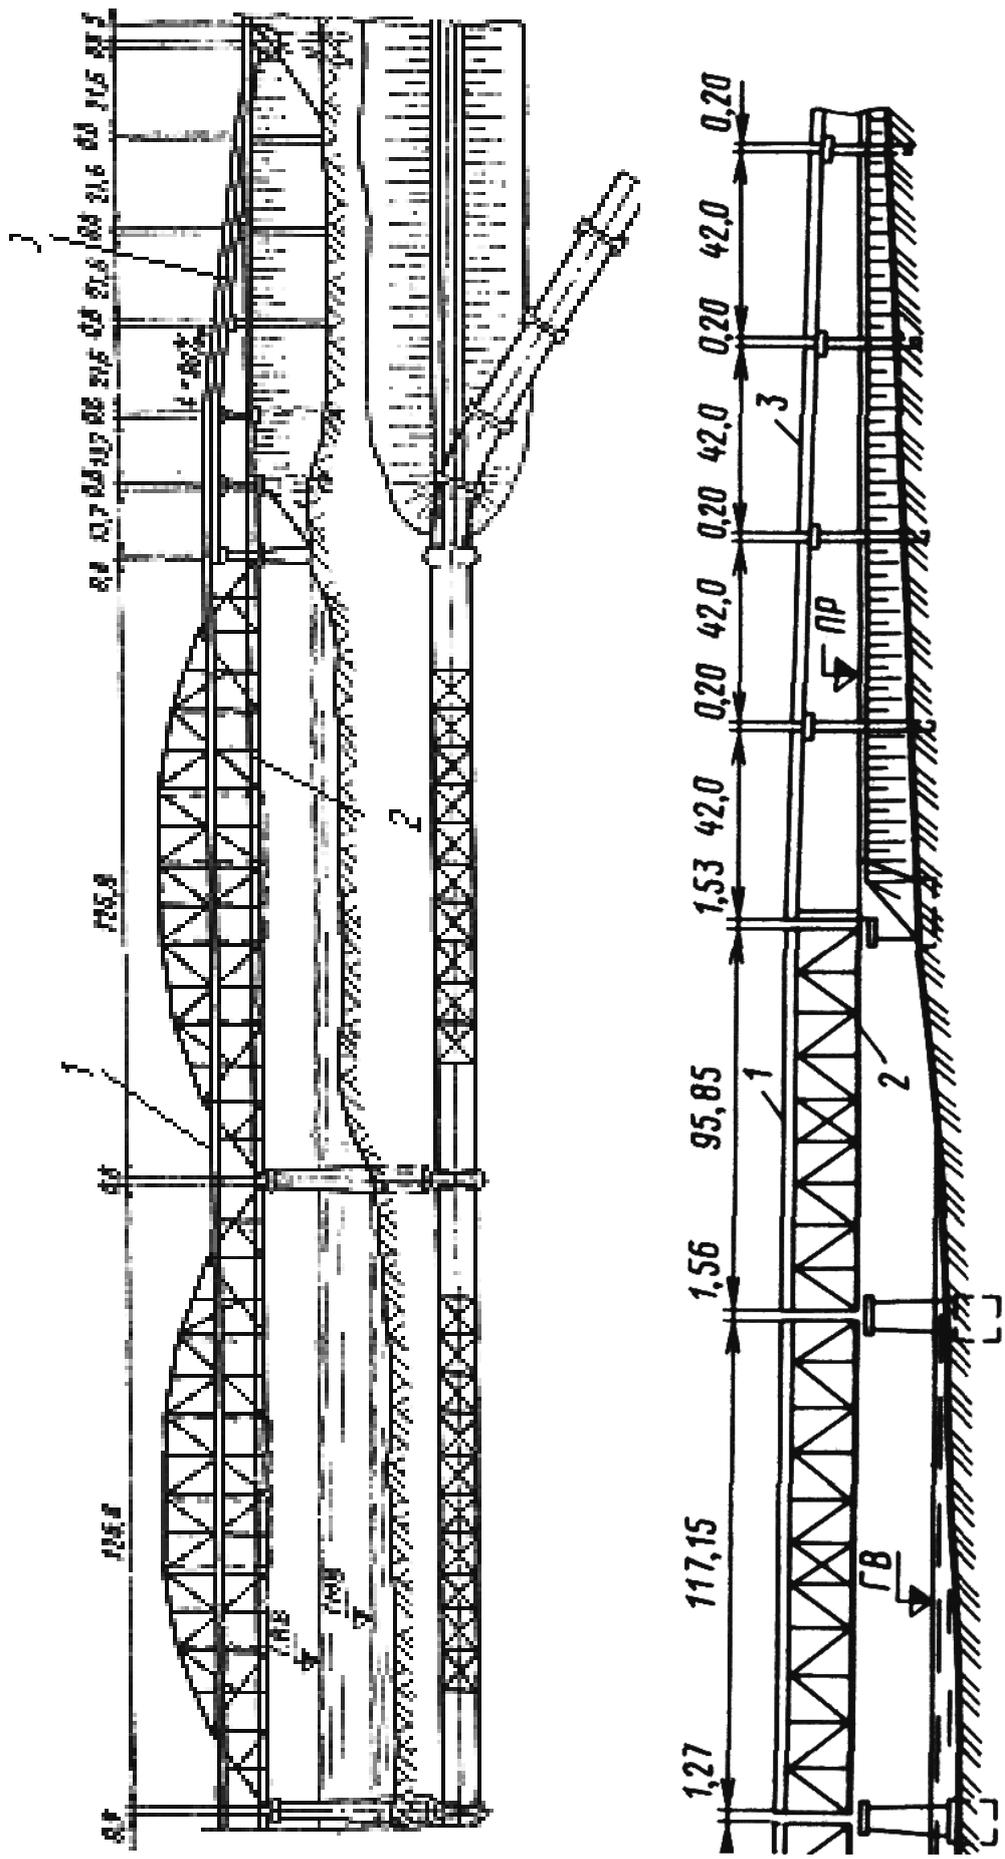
Схема реконструкции железнодорожного моста под совмещенную езду: сверху – по старым пролетным строениям, внизу – по новым; 1 – автомобильная проезжая часть; 2 – железнодорожная проезжая часть; 3 – эстакада
